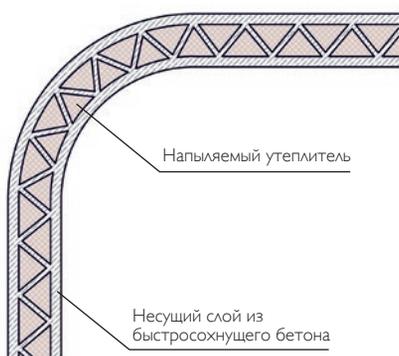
Схема плана напечатанной на 3D-принтере стены (в разрезе)
